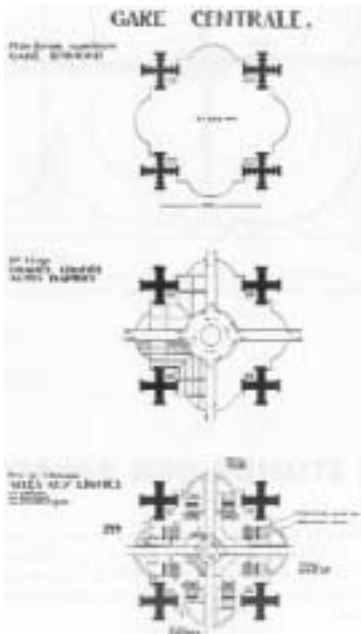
Zentraler Platz; Plattform bis Erdgeschoß
